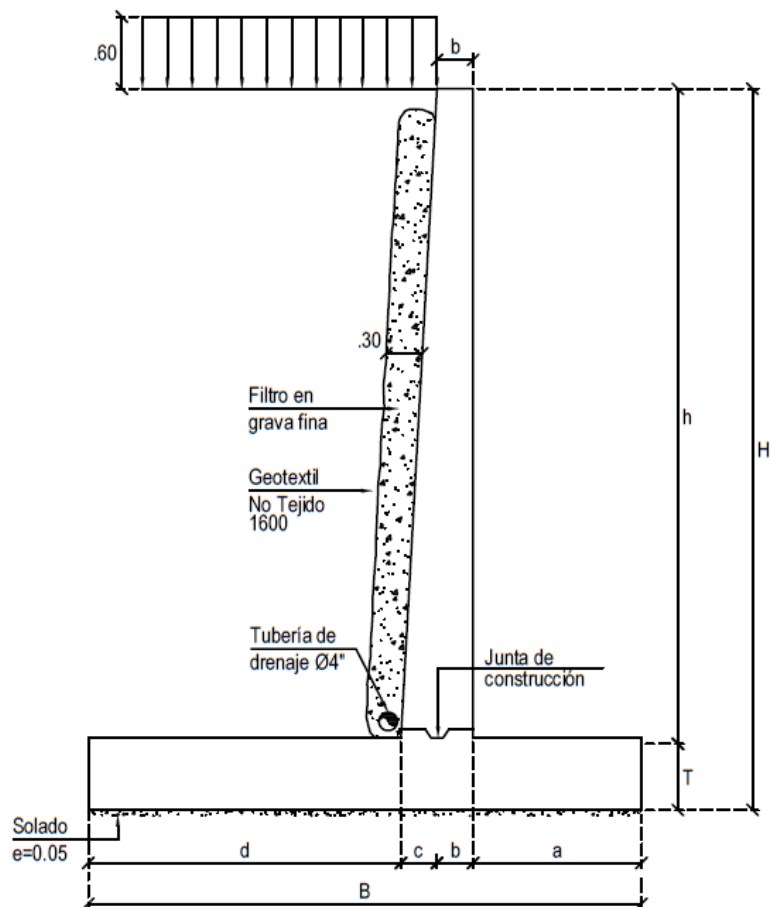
Geometría del muro de concreto en voladizo. INVIAS (2013).
